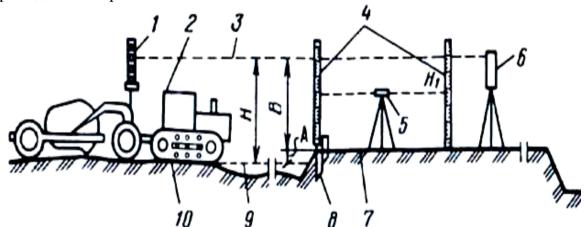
Схема привязки излучателя к плоскости рисового чека: 1-фотоприемное устройство; 2-тягач; 3-луч лазера; 4-рейка; 5-нивелир; 6-лазерный излучатель; 7-насыпь картового оросителя; 8-временный репер; 9-средняя плоскость чека; 10-поверхность чека
